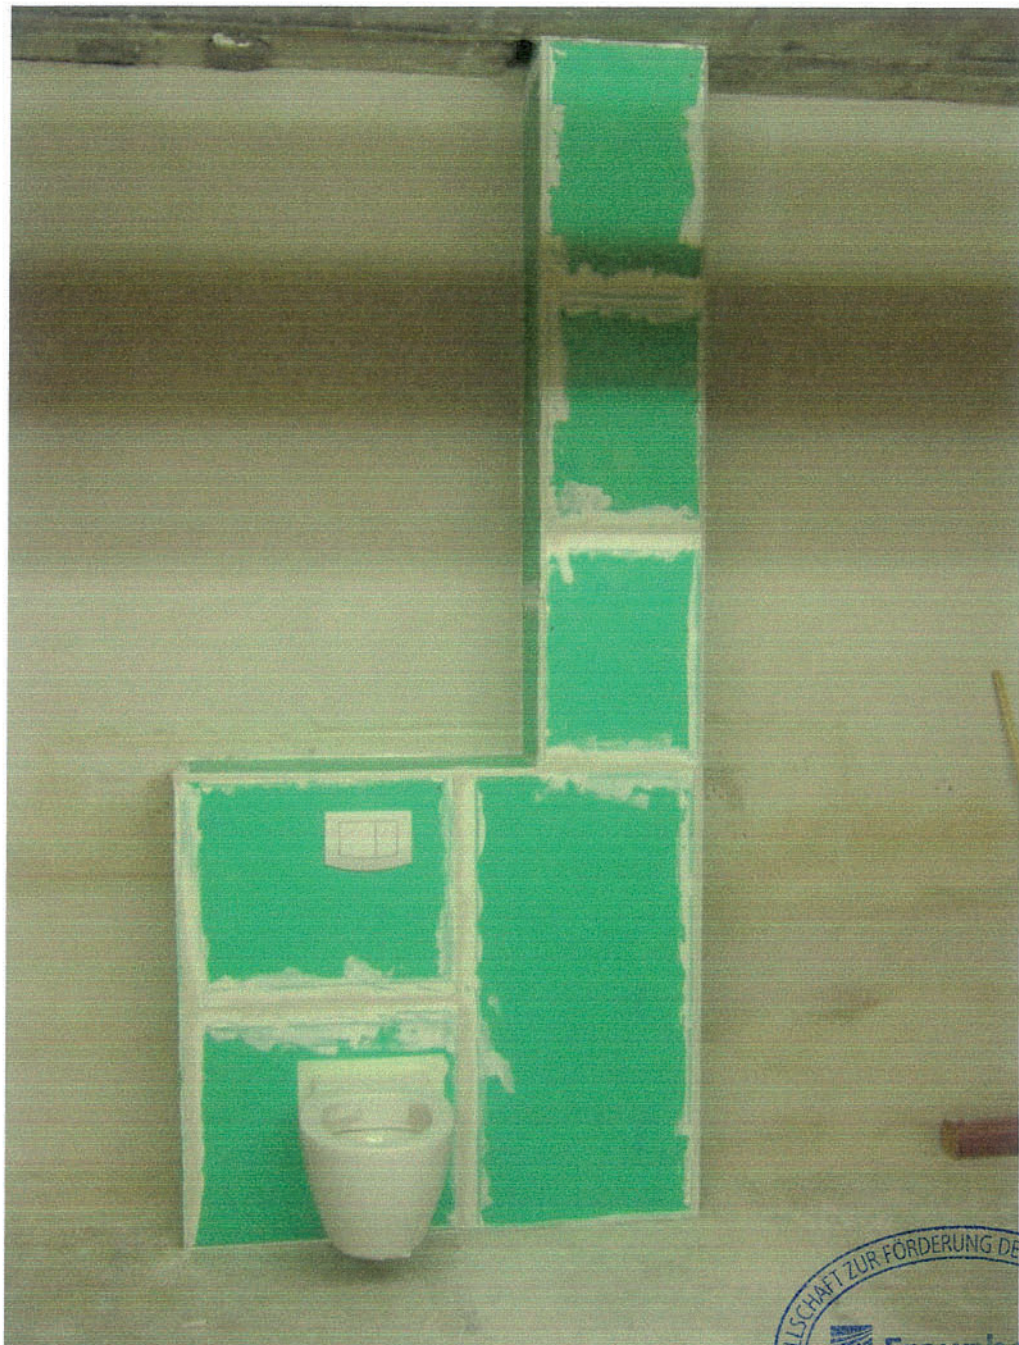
WC-Musterinstallation im Raum G vorne des Prüfstandes. Im Raum UG vorne war lediglich ein Installationsschacht angebracht. In den Deckendurchbrüchen waren die Rohrleitungen mit Conlit Brandschutzschalen einbetoniert (siehe Bilder 5 und 6)
